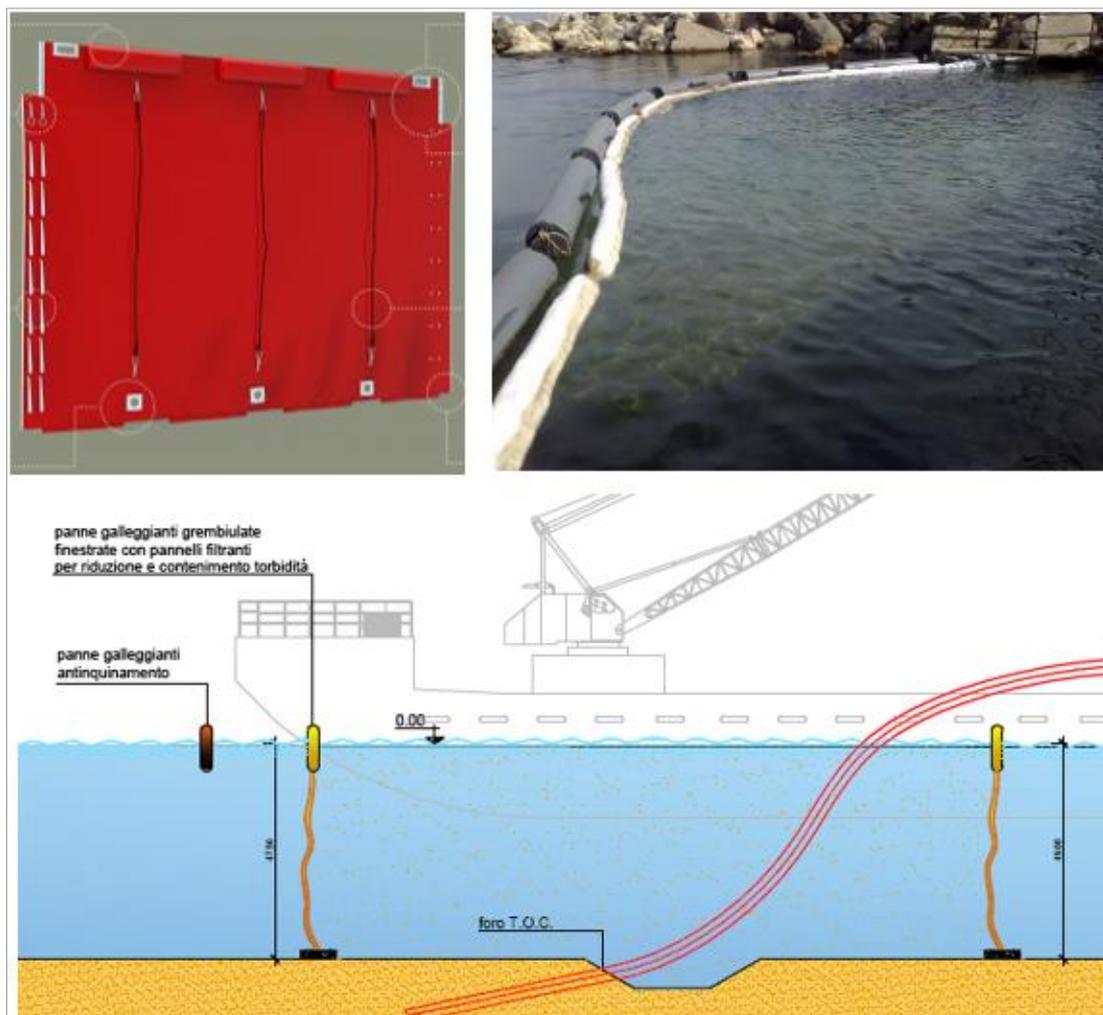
Esempio di sistemi di protezione contro torbidità e sversamenti a mare
